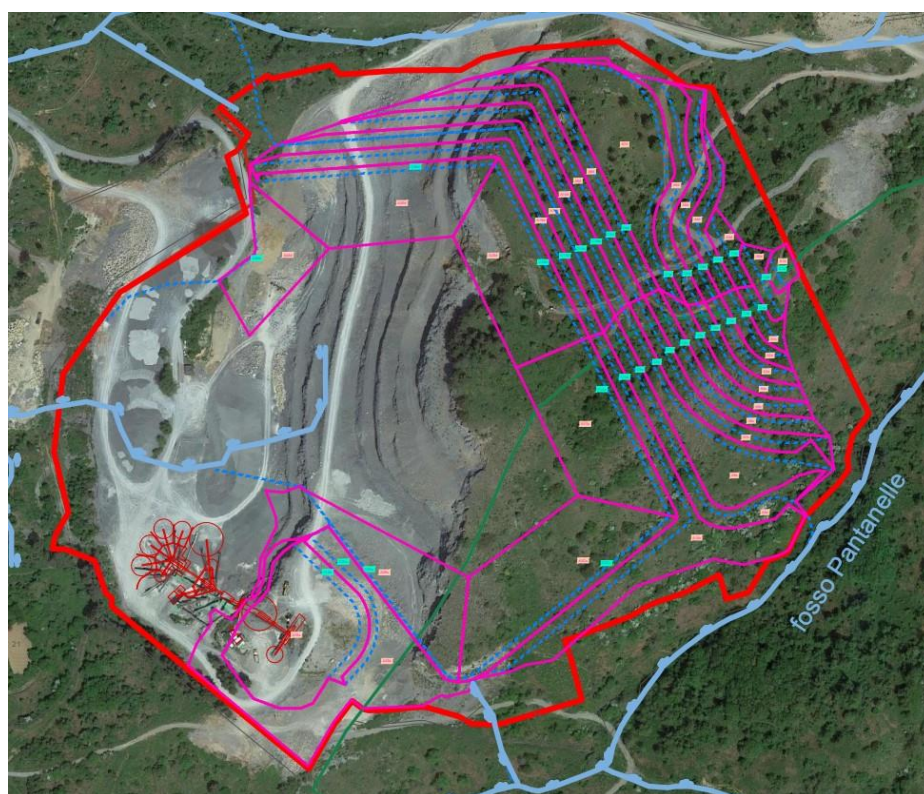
Planimetria Recapito Finale Acque Meteoriche Stato Finale
